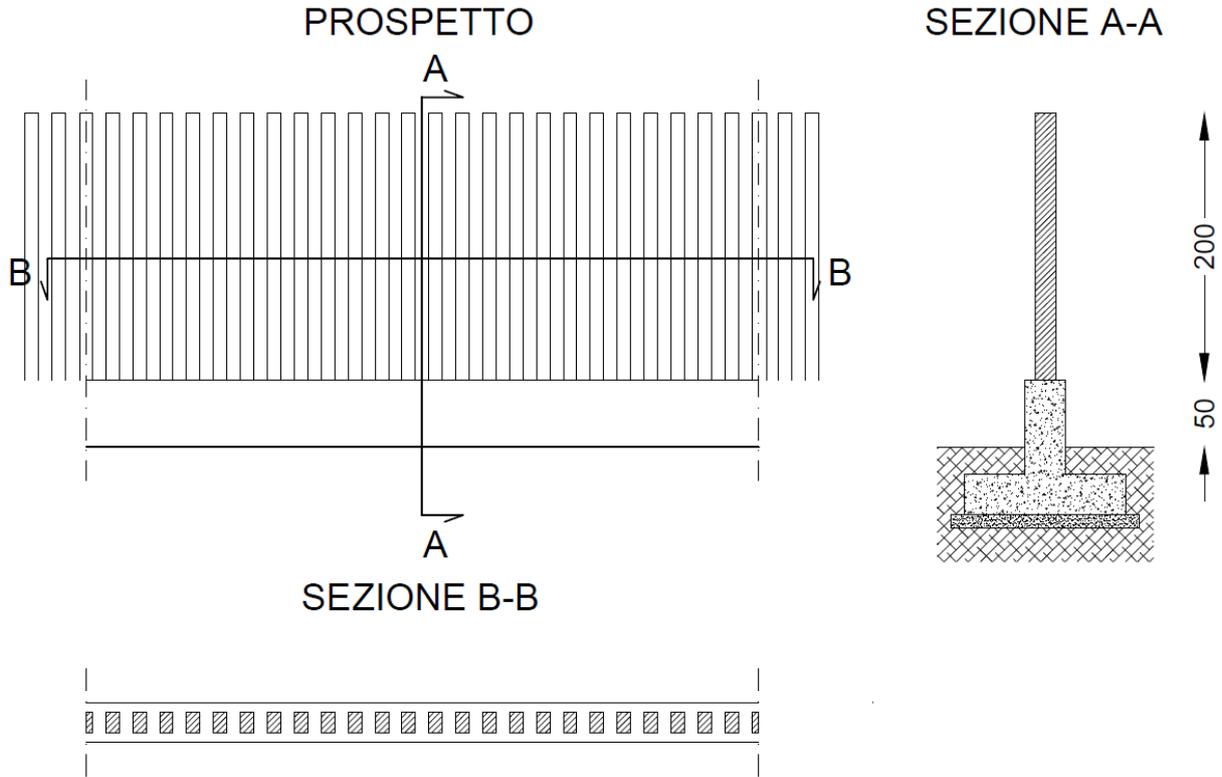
Particolare recinzione con fondazione – tutte le misure in cm
